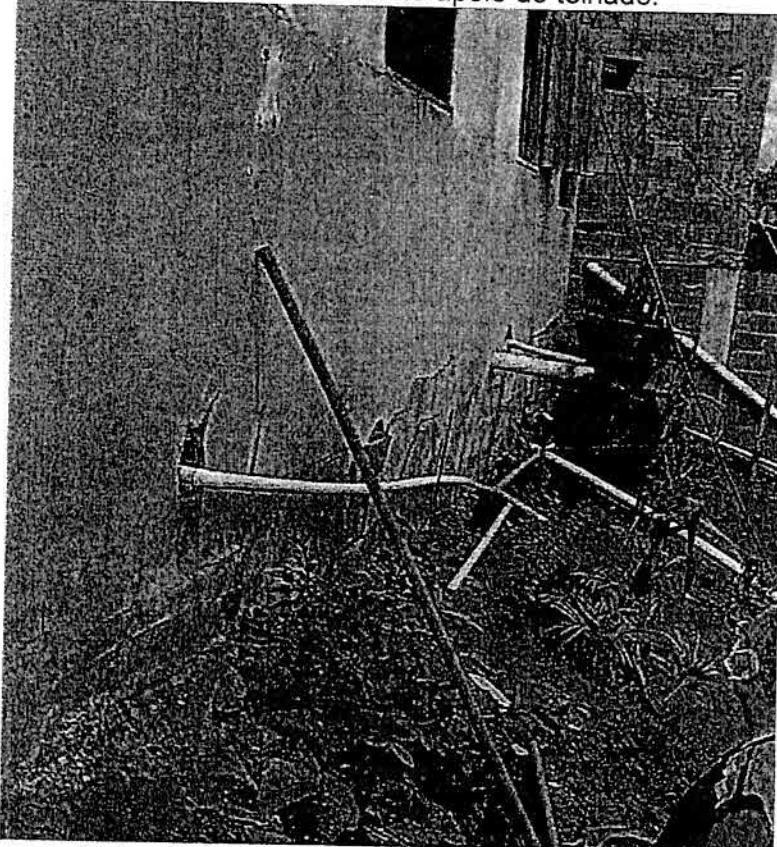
Abatimento de parede construída sobre aterro.
